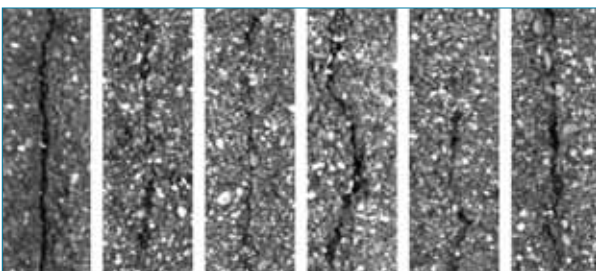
Imágenes de grietas y fisuras longitudinales de la base de datos.
